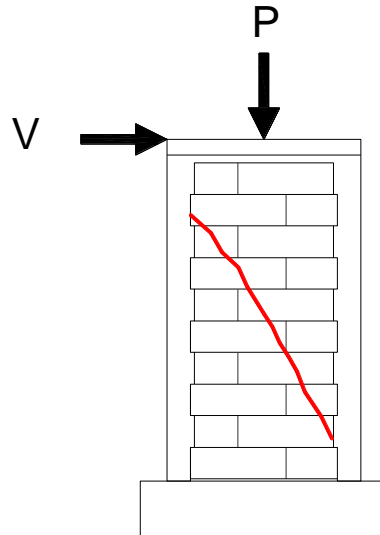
Grieta de cortante en un muro confinado
